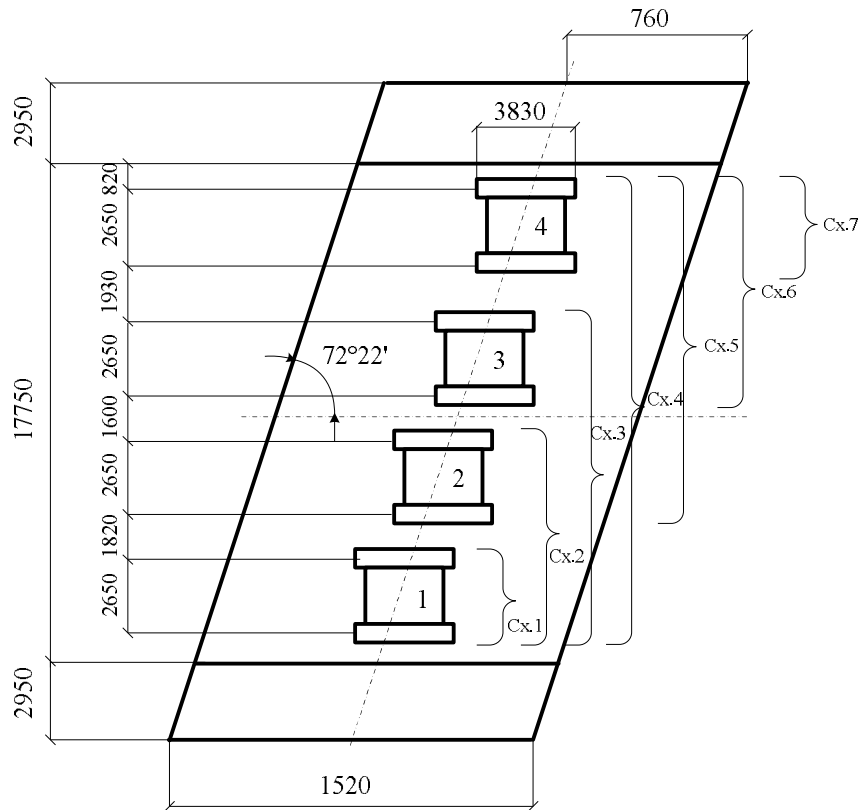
Схемы загрузки пролетного строения испытательной нагрузкой
